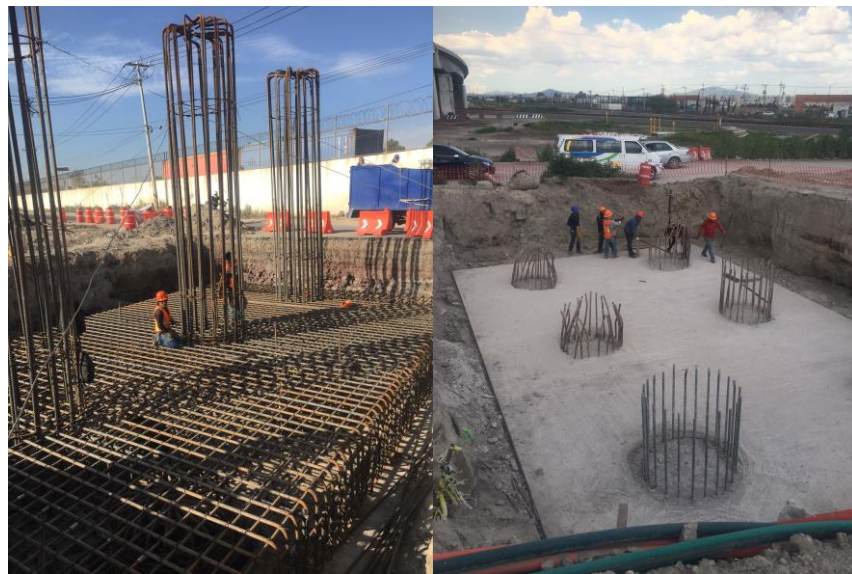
NOTA: Adaptado de Plantilla y armado de Zapata, Autoría Propia, 2023
